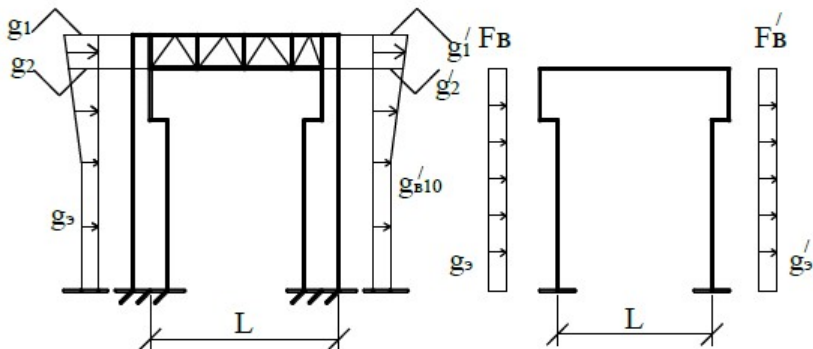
Схема приложения ветровой нагрузки к поперечной раме
